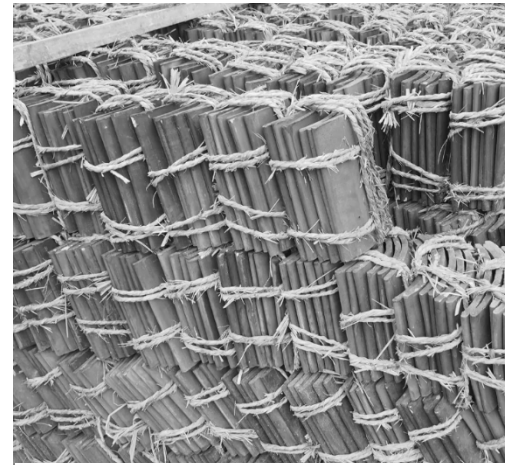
Eiichi, K. (2015). Tejas usadas en la cubierta y fachada del museo [Fotografía]
